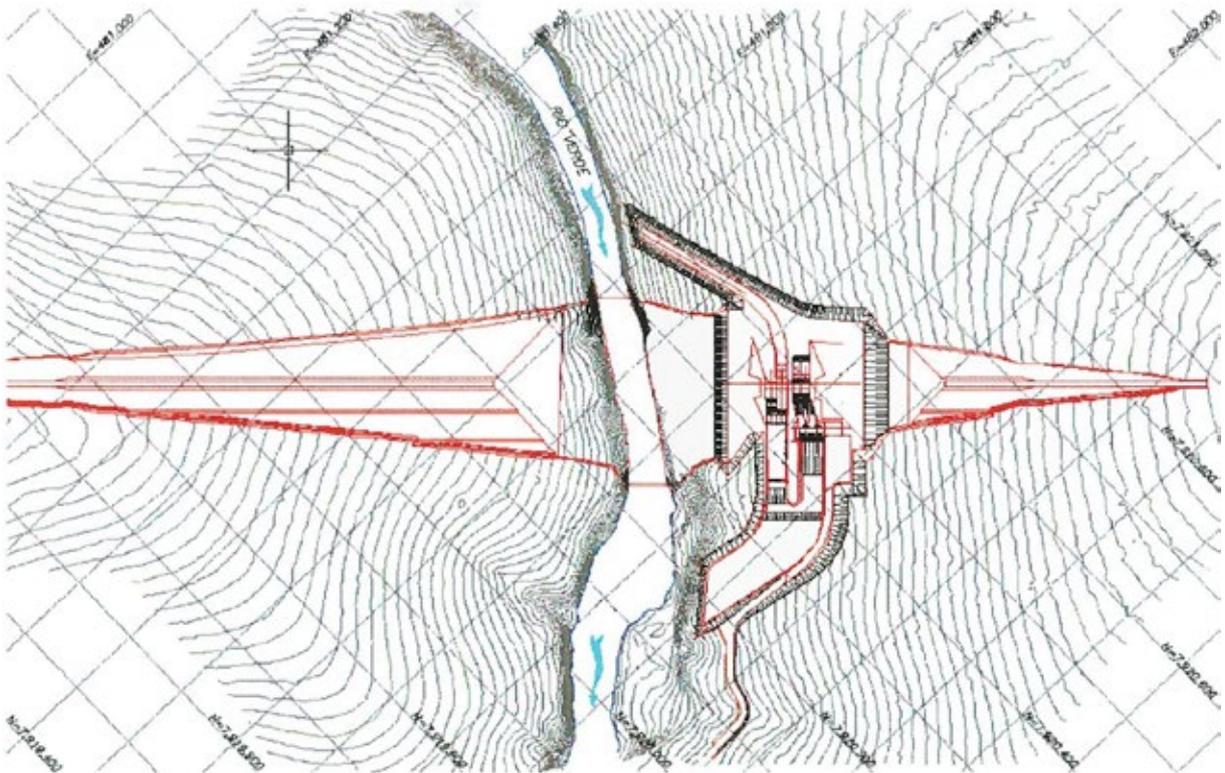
Desvio do rio feito em uma única fase. Construção das estruturas definitivas e galerias de desvio, a seco. UHE Salto, GO.
